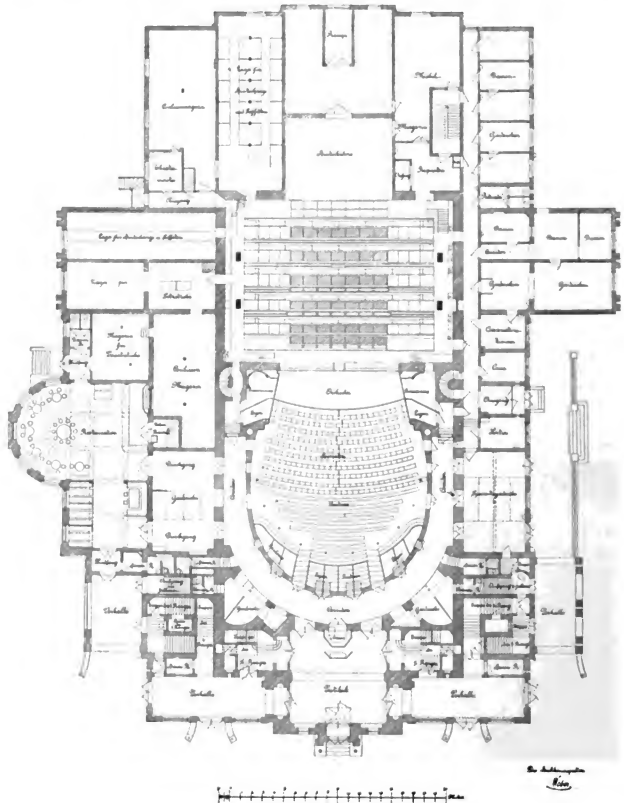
Jetziger Grundriss des Stadttheaters.
